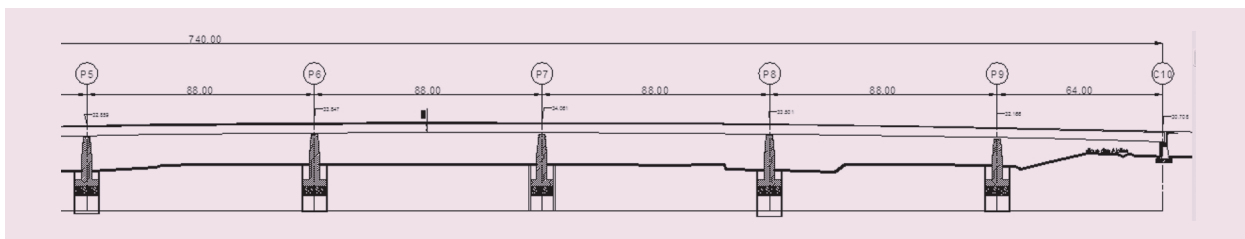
coupe longitudinale de la solution mixte sur la partie droite en rivière
